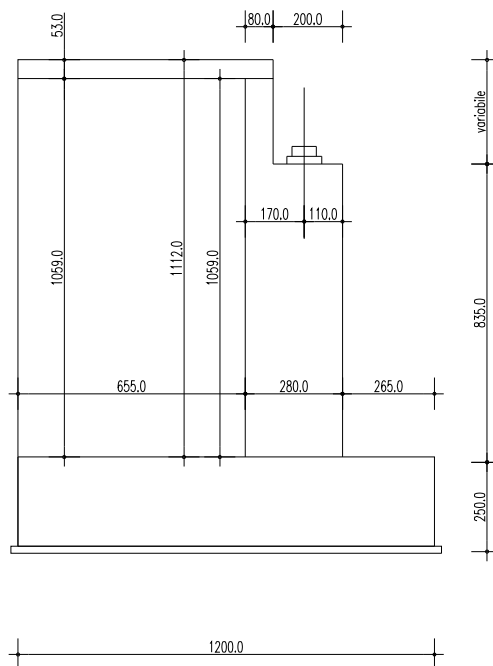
Vista laterale Spalla B 3.
